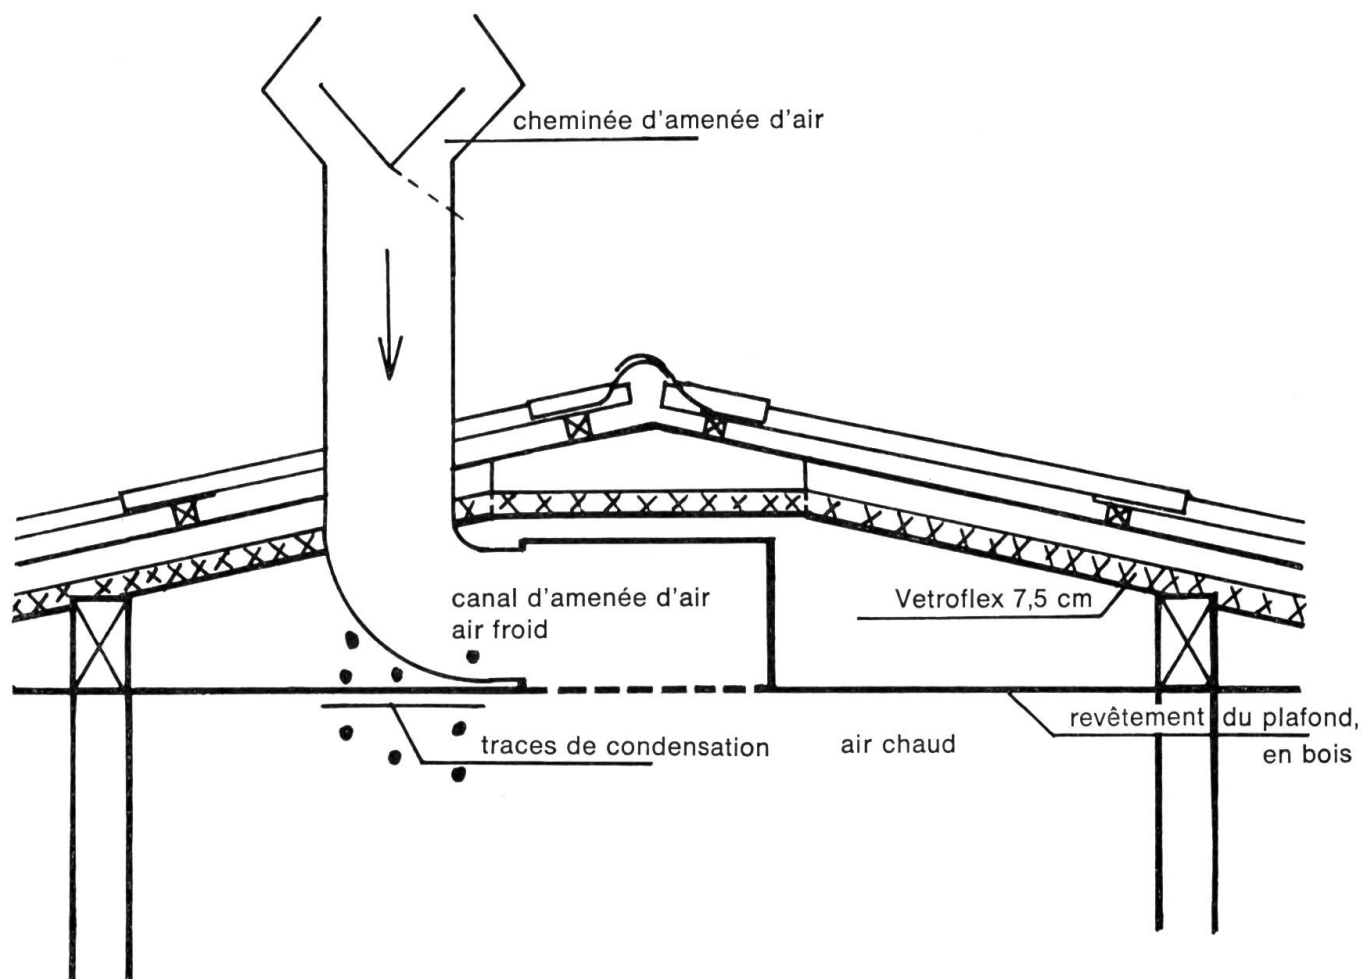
Formation de condensation le long du canal d'amenée d'air non isolé, en dessous de l'isolation. On constate aussi la formation de condensation au plafond (lambrissage), car l'espace entre le plafond et le canal d'amenée d'air est refroidi.
